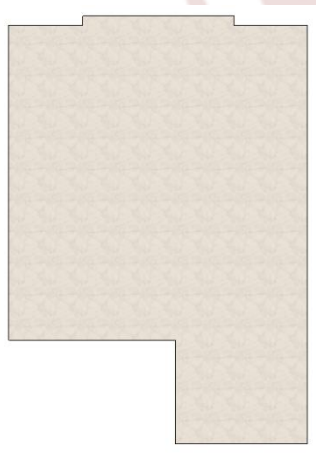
Alternatif 2 Rencana Lantai *Standard Room
